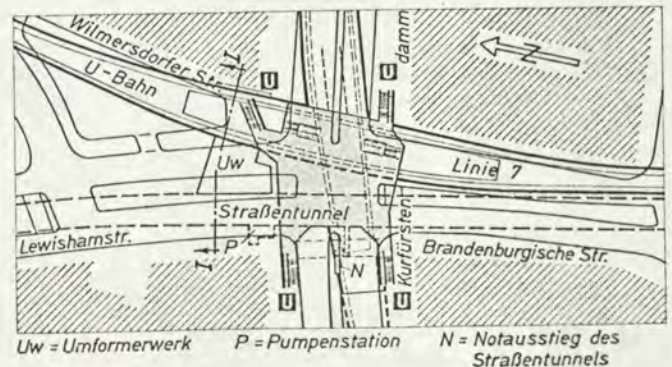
(rechts): U-Bahnhof Adenauerplatz und Straßentunnel, Lageplan
